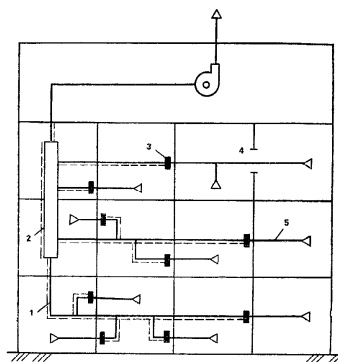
Системы вентиляции с огнезадерживающими клапанами для помещений категорий А, Б или В:
